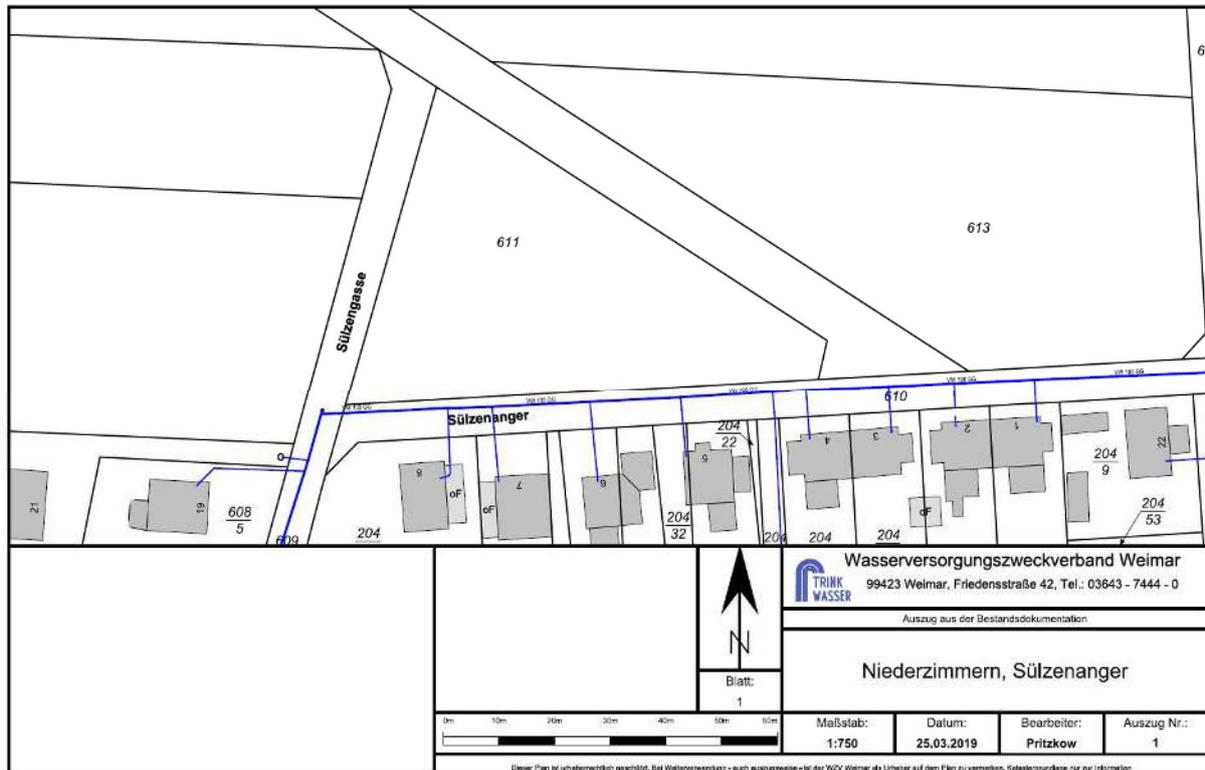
Plangebiet, Trasse Trinkwasserleitung
